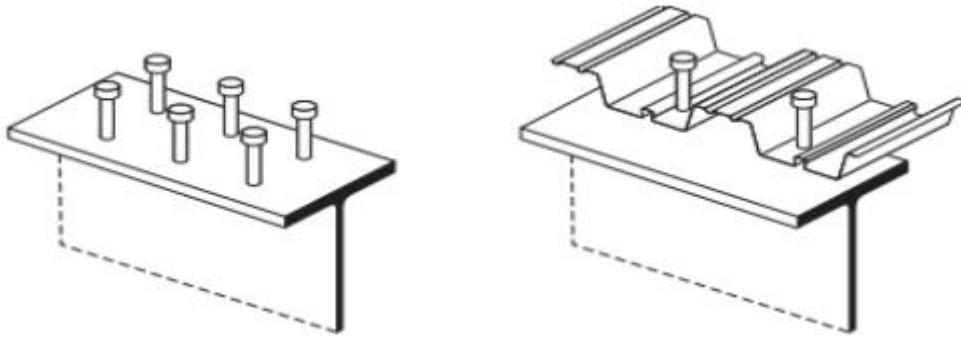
goujons à tête (pour dalle pleine ou dalle mixte)
